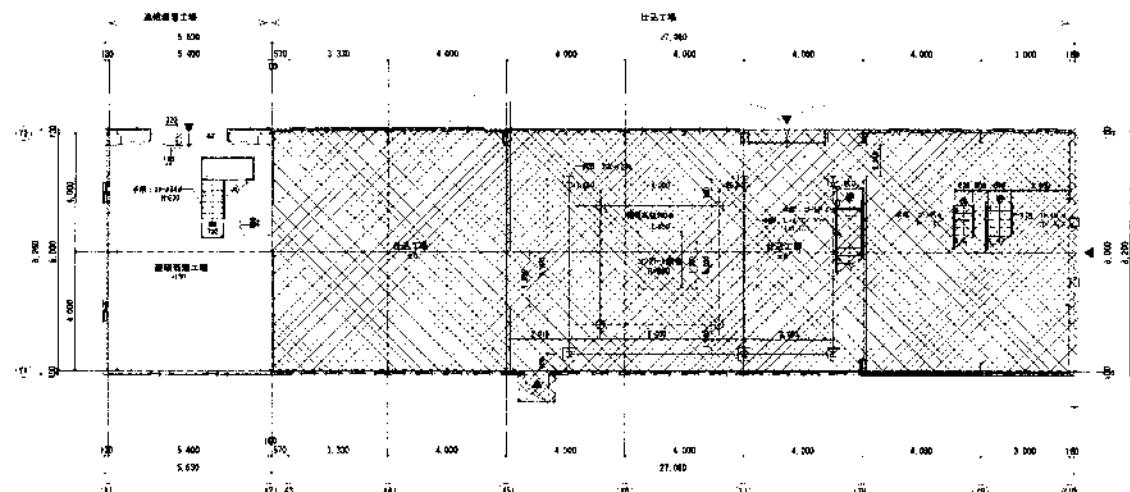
連続蒸溜工場 平面図 (株式会社シン技術コンサル提供)
